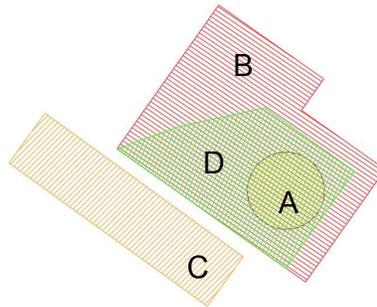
Planimetria "tipo" delle aree di servizio durante la costruzione
